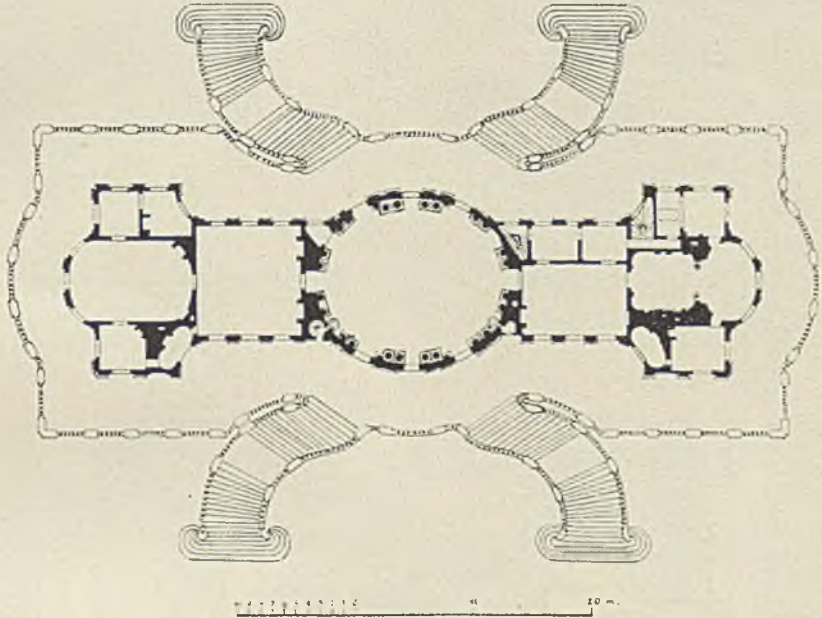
Grundriß von Schloß Solitude bei Stuttgart
